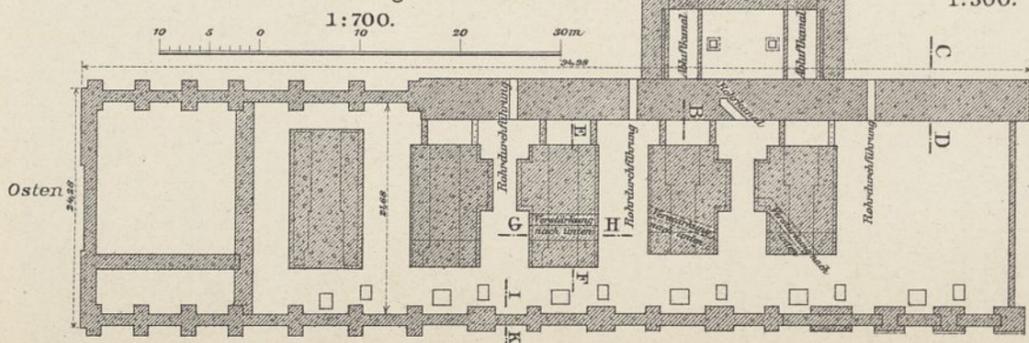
Maschinenhaus. Gründungsplan. 1:700.
